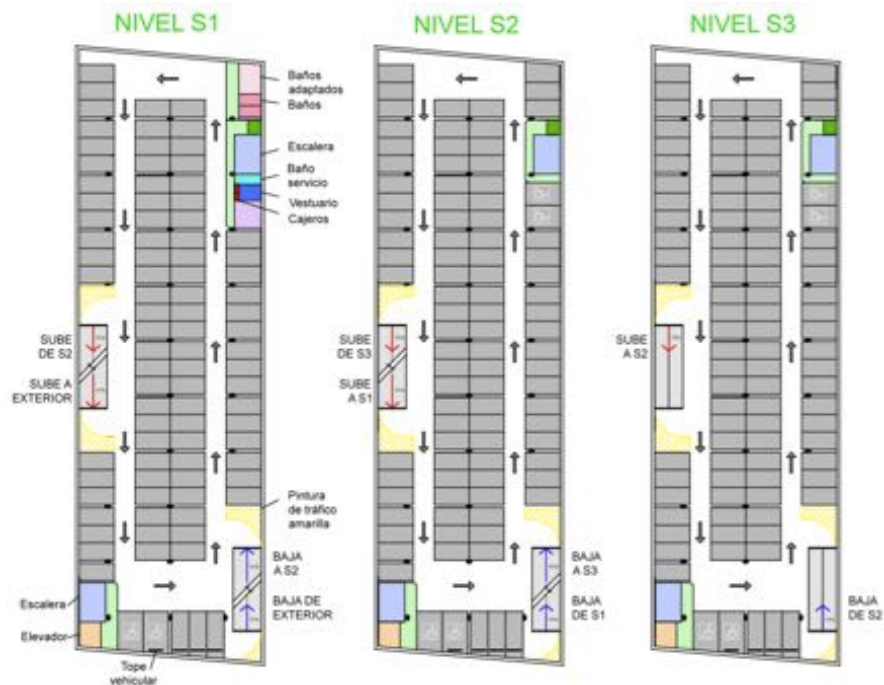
Alternativa 2 – Ubicación 1 y 3 Plantas
